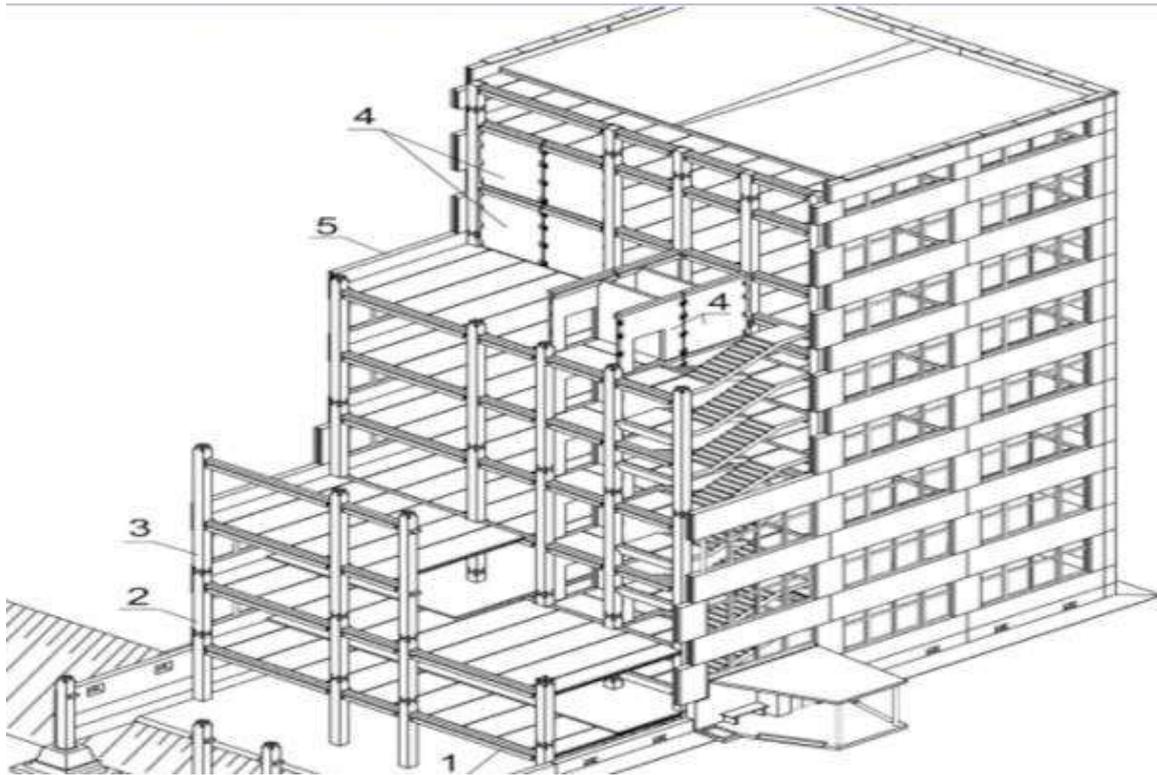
Конструктивне рішення типової багатоповерхової промислової будівлі: 1 – перекриття; 2, 3 – колони; 4 – вертикальні діафрагми жорсткості; 5 – навісні стінові панелі
